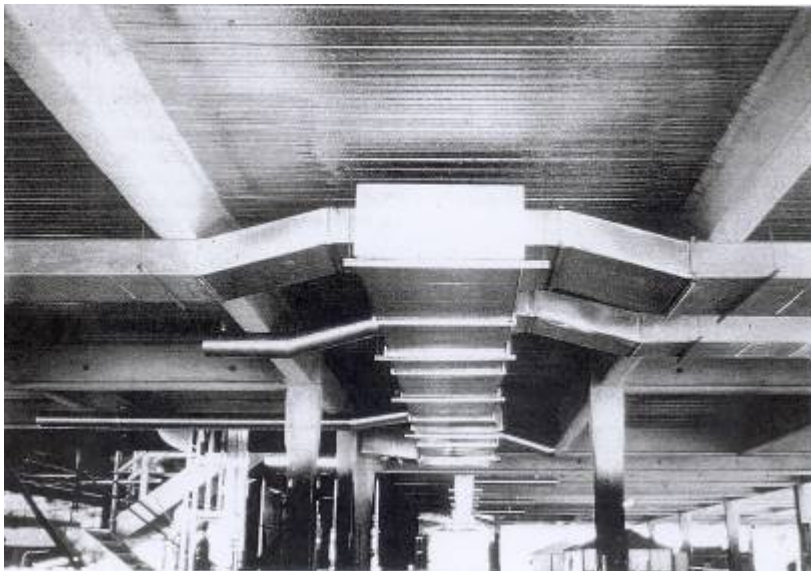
Různé typy integrace technického zařízení do konstrukce [3]
